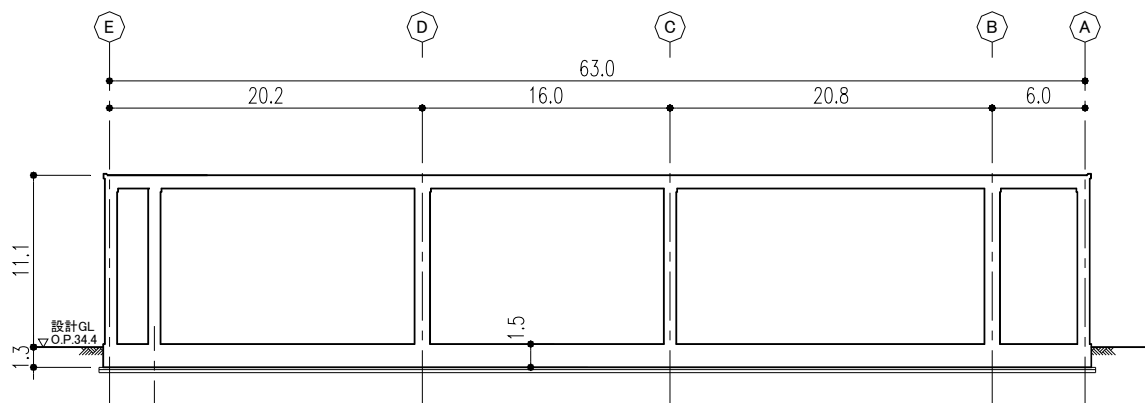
スラッジ棟 B-B断面図 (EW 方向) (単位 : m)
